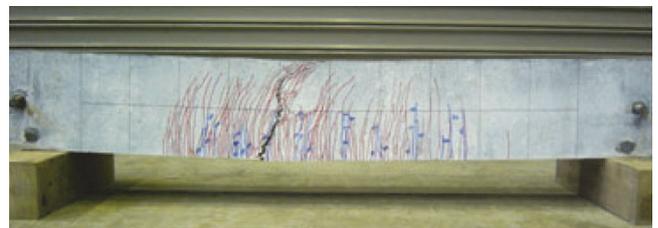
曲げ実験におけるひび割れ発生状況<sup>1)</sup>
